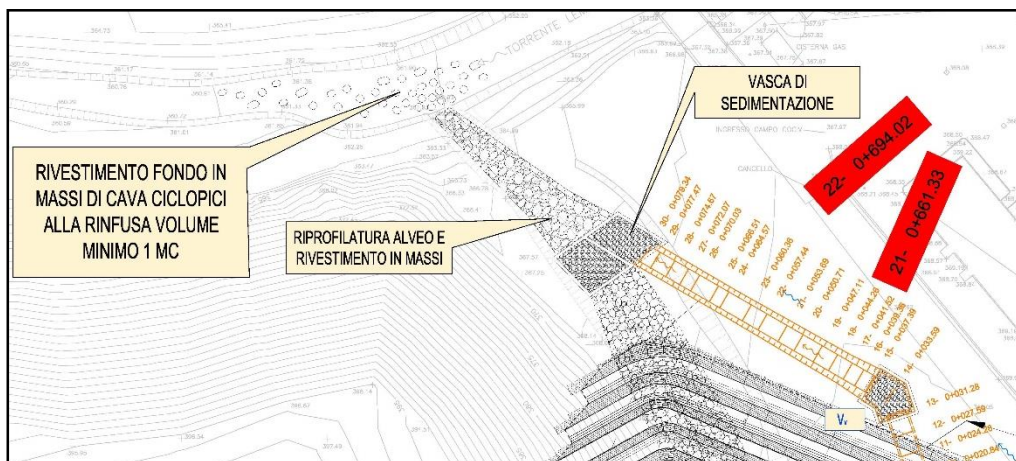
Scarico Nord. Rivestimento fondo t. Lemme con massi di cava ciclopici alla rinfusa. Planimetria
